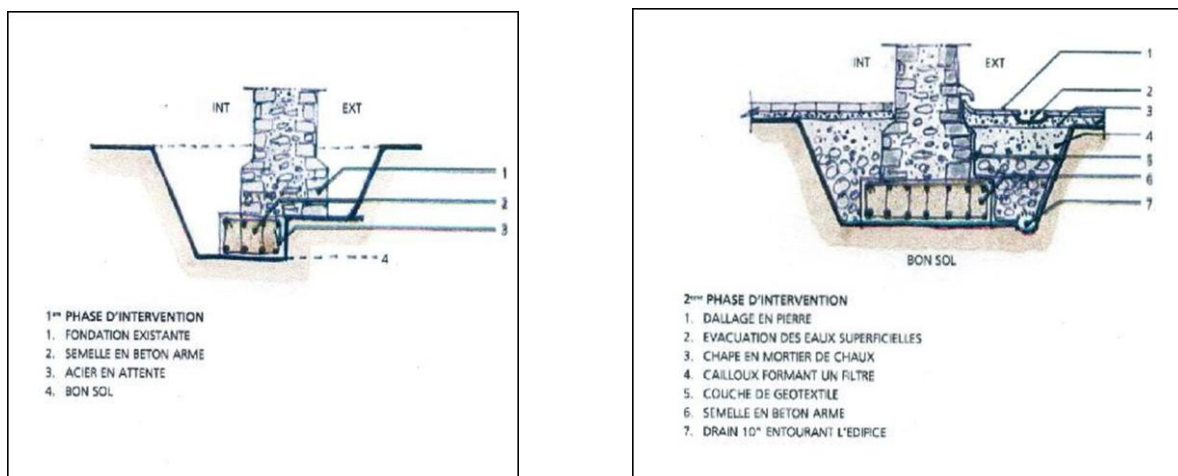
Consolidation de la fondation en sous-œuvre par maçonnerie
